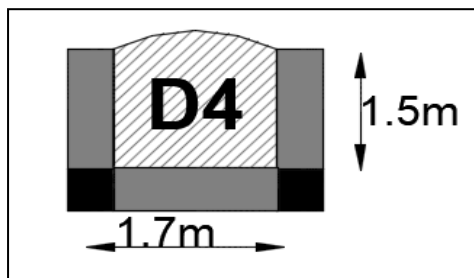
Schéma de ferrailage de la dalle sur trois appuis (séchoir) .
